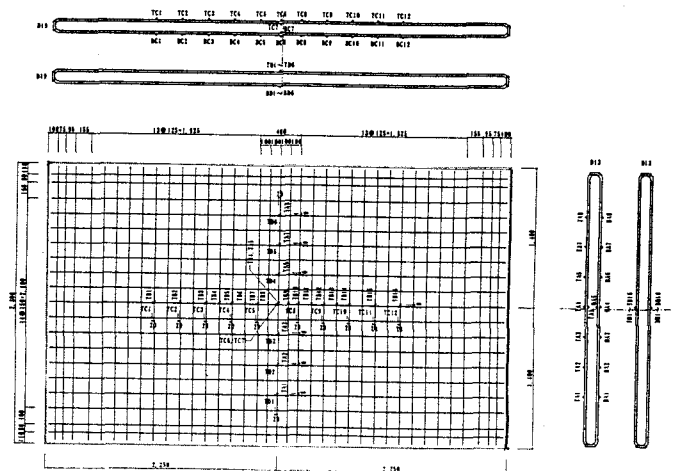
床版鉄筋ひずみゲージの取付位置 (単位: mm)
